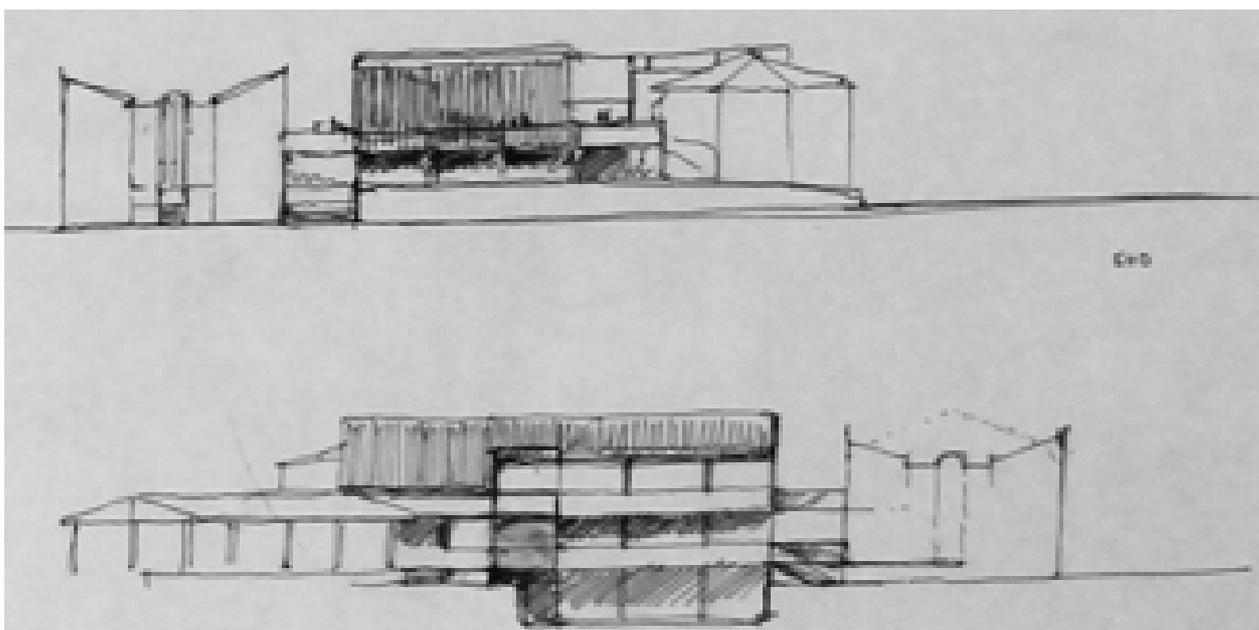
Prospetti Sud-Nord, stato futuro – 09/11/1993 (AABS-64_254)
